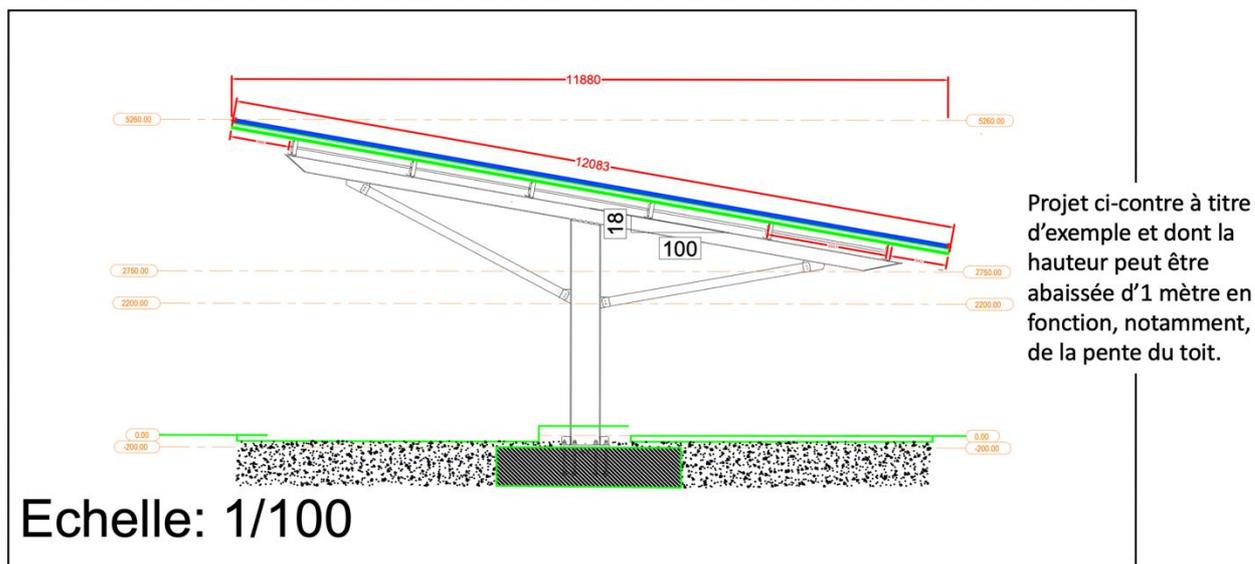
Zone 2 - vue en coupe de l'ombrière. Intervalle d'environ 10 mètres entre chaque poteau + gouttière
